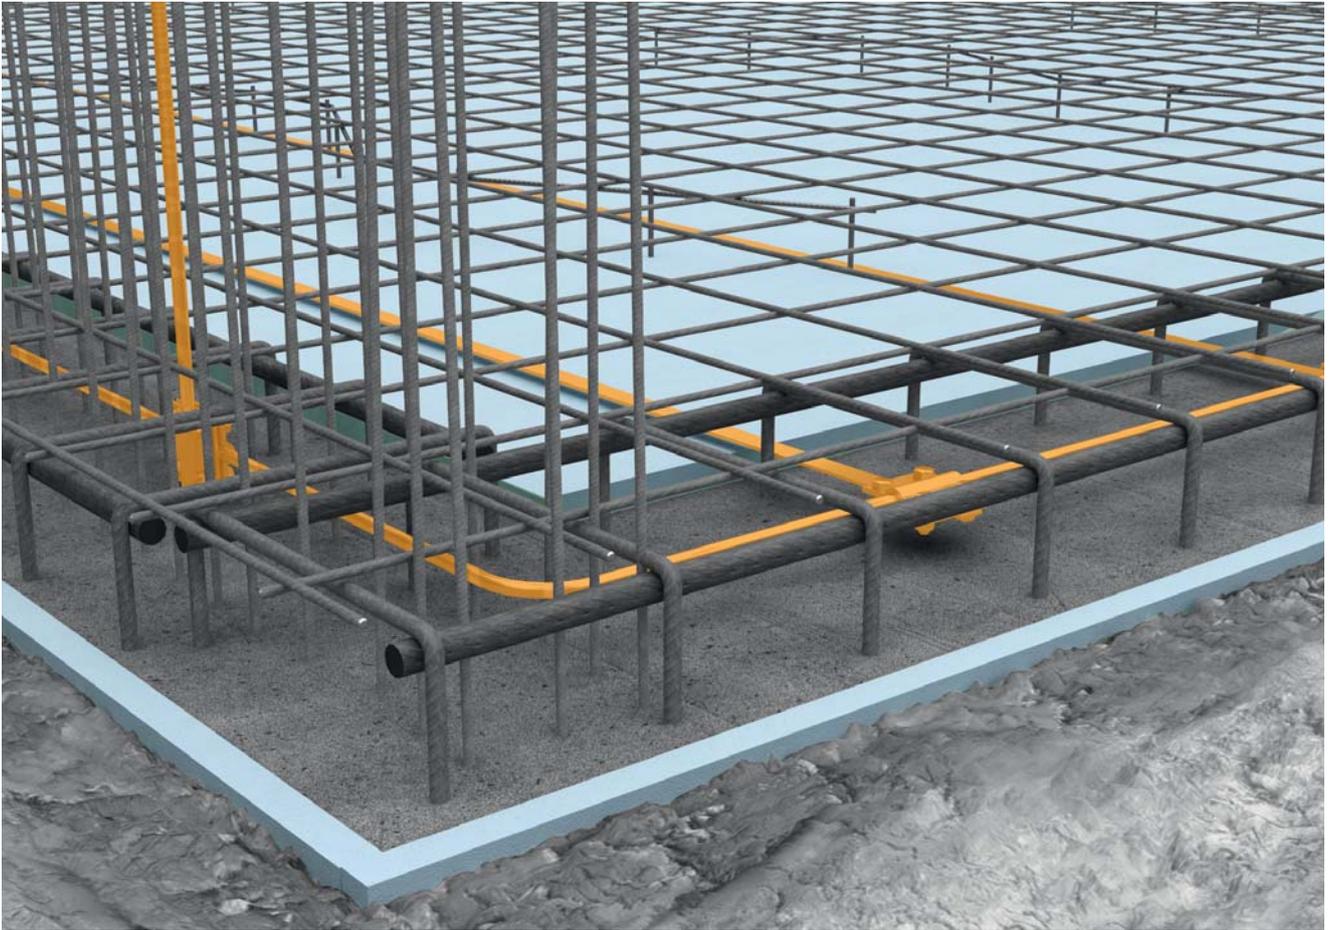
Изолированная фундаментная плита (изоляция по периметру, здесь: голубая)
